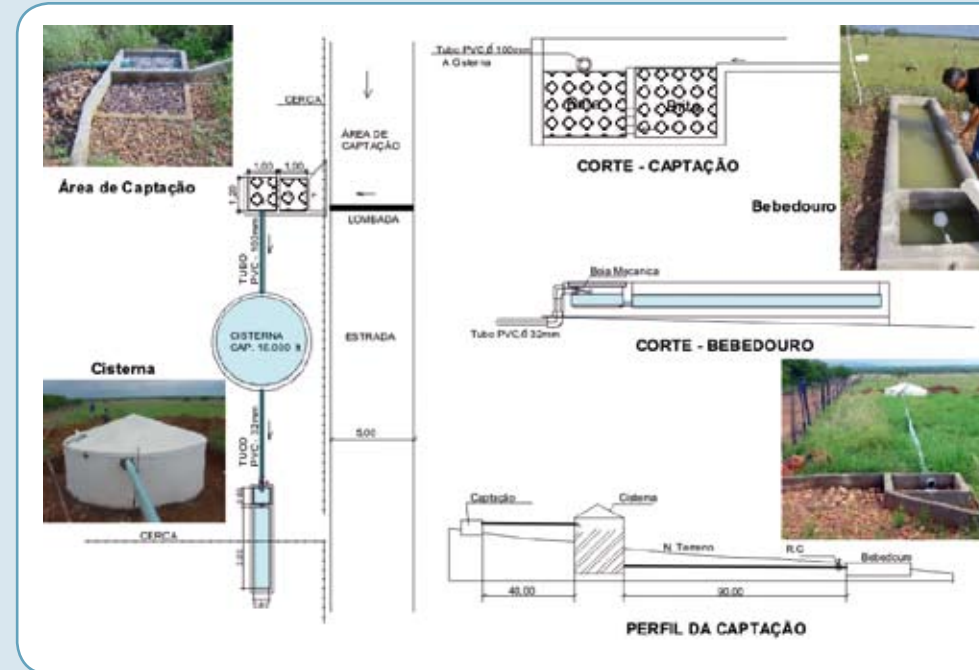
Planta baixa do sistema contendo a área de captação, o sistema de filtragem, a cisterna e o bebedouro dos animais.
